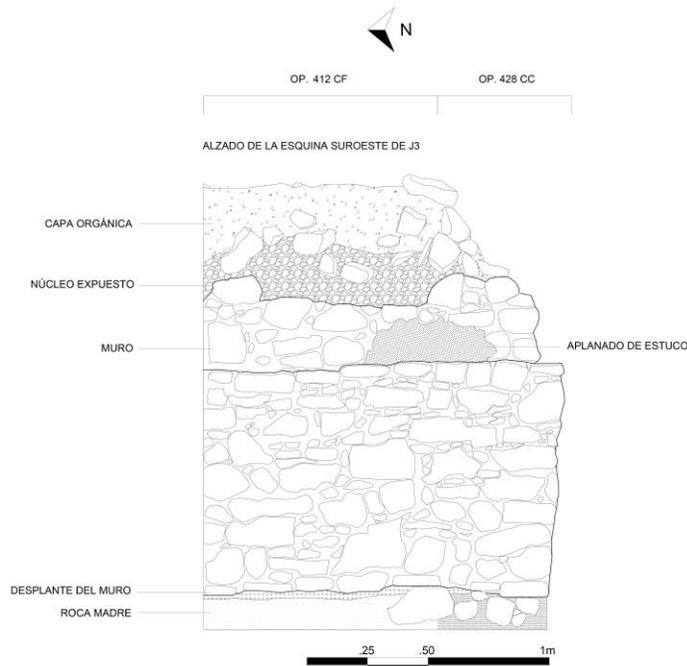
Alzado de la esquina SW de J3. Se aprecia el sistema constructivo de la estructura.
